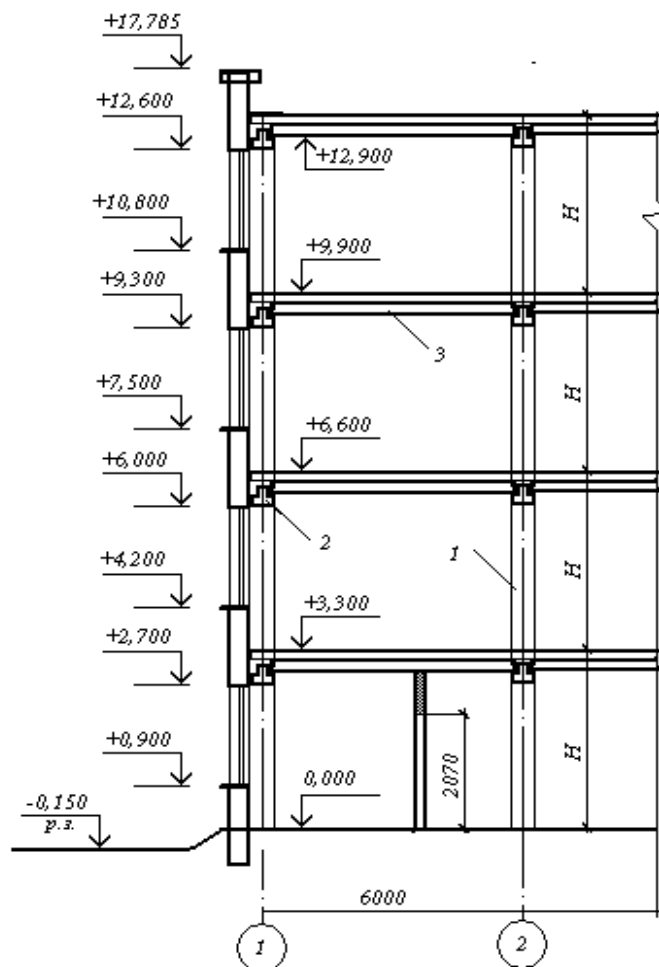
Розріз будівлі з укладкою збірних панелей на ригелі: Н – висота поверху; 1 – колона; 2 – ригель; 3 – плита перекриття
